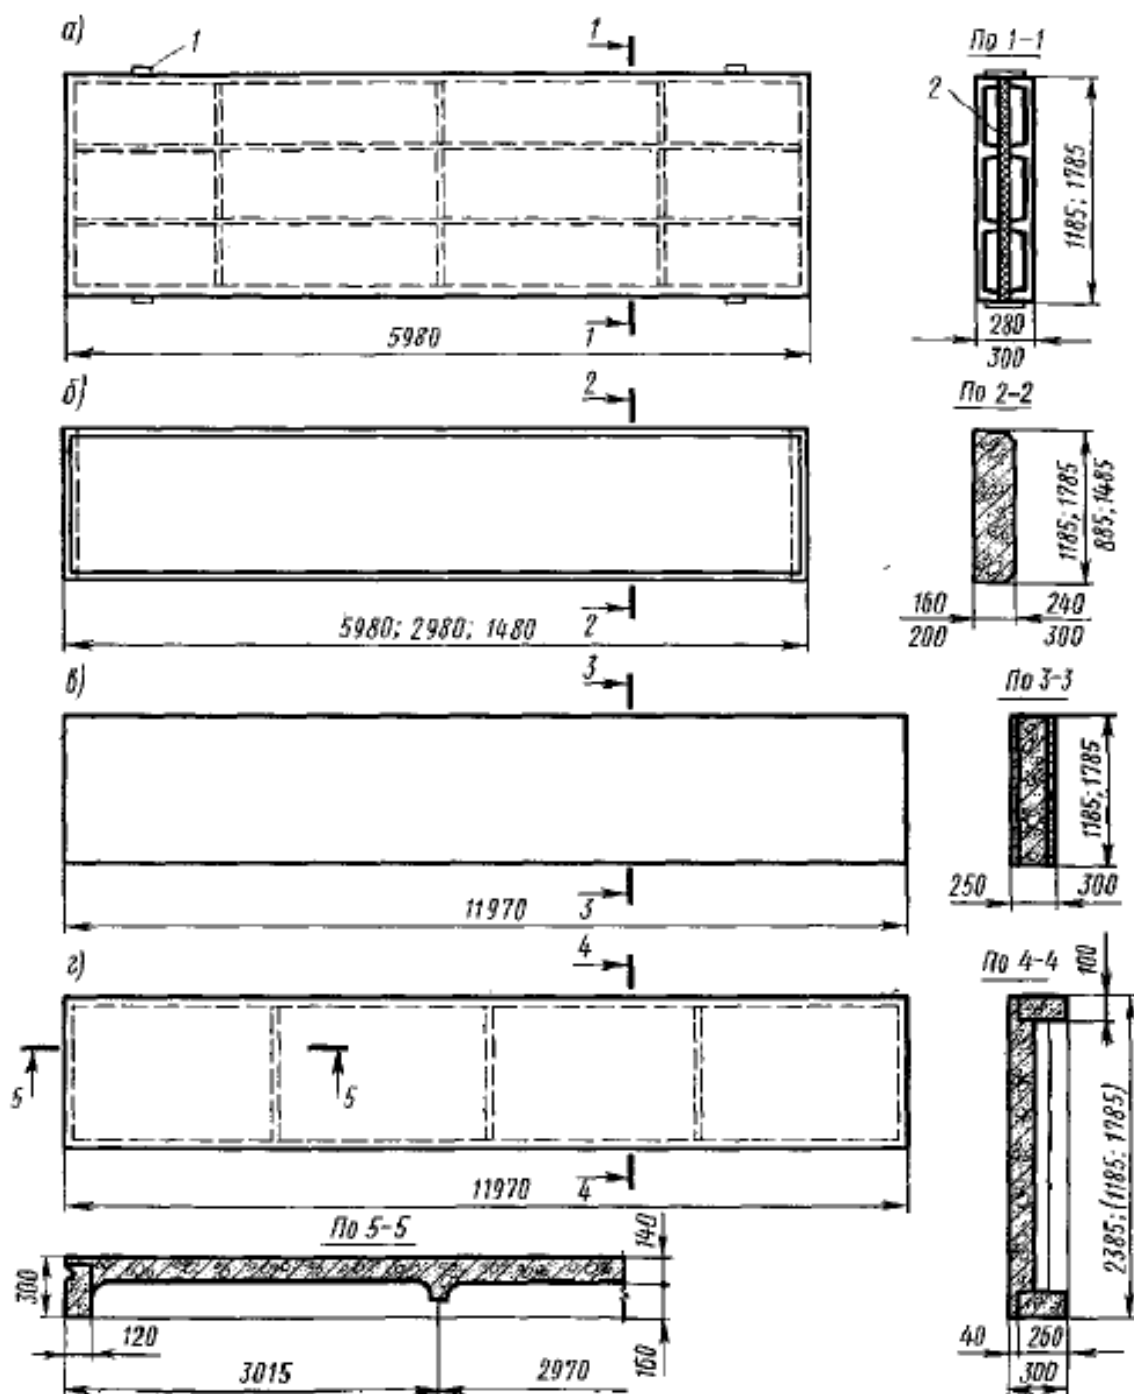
Стеновые панели для отапливаемых зданий:
